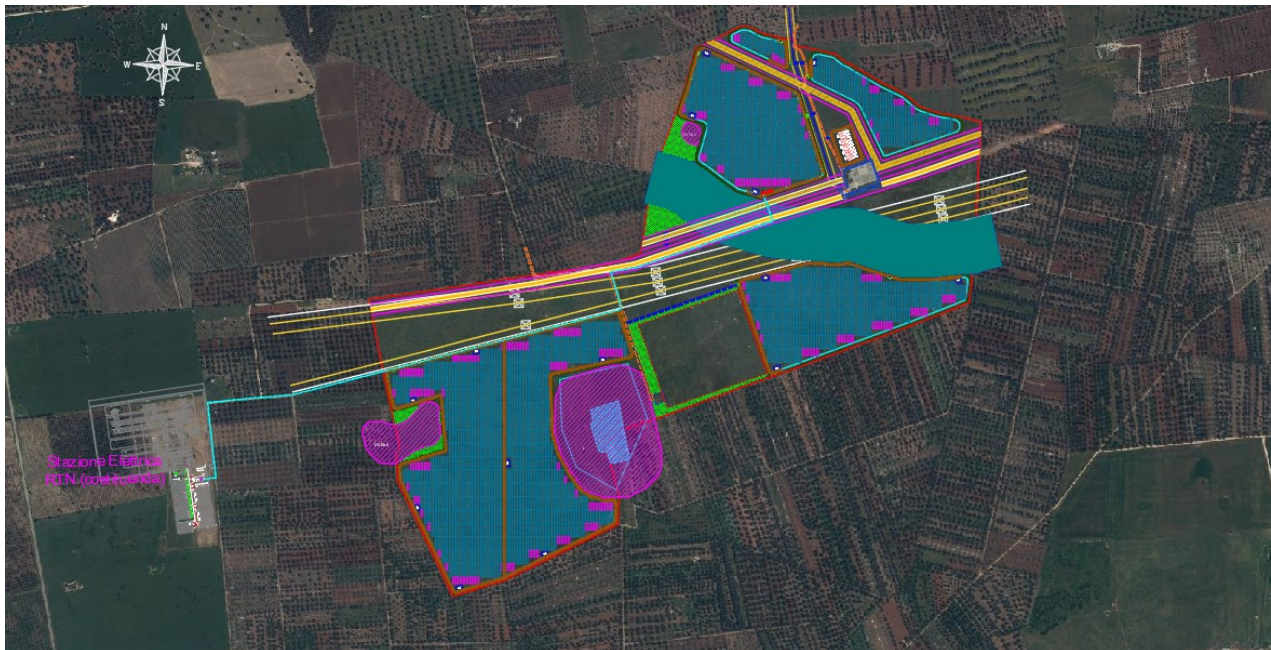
Ortofoto riportante tutta l’area interessata dall’intervento
